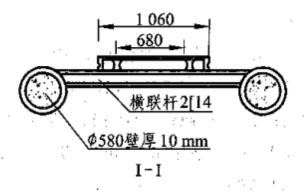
拼装式钢管混凝土台座(单位: cm)
